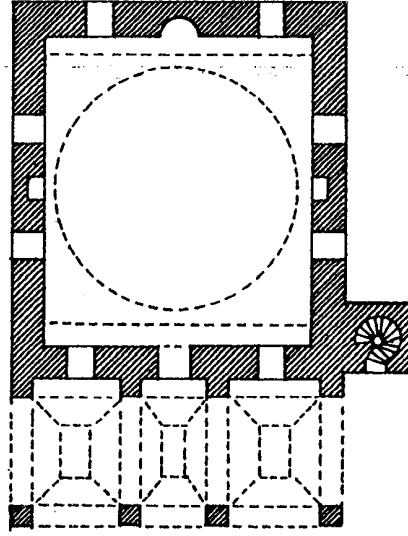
مسقط أفقي لمسجد ياكوفالي
